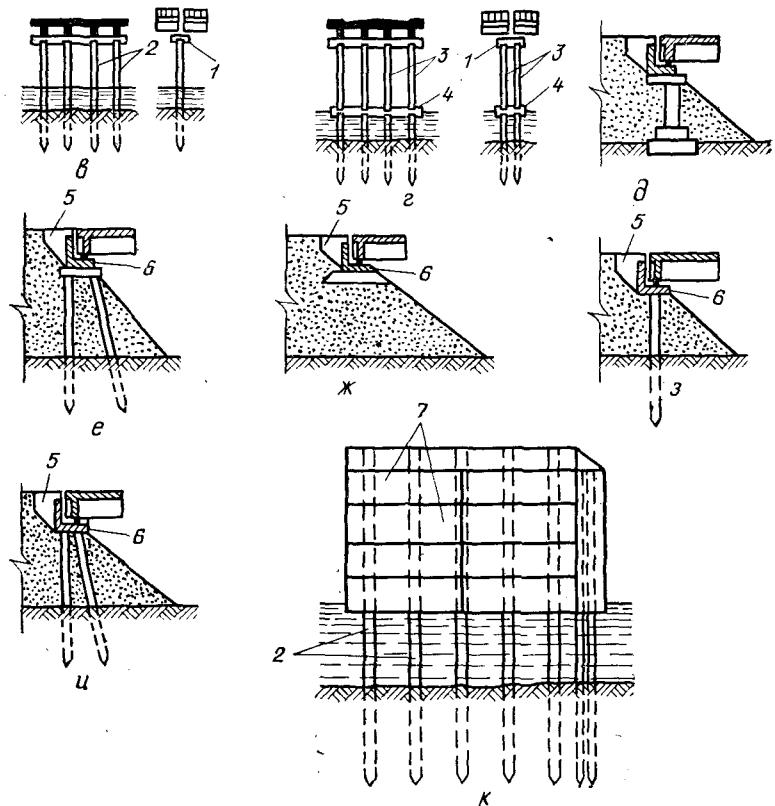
Виды свайных промежуточных и береговых железобетонных опор:
